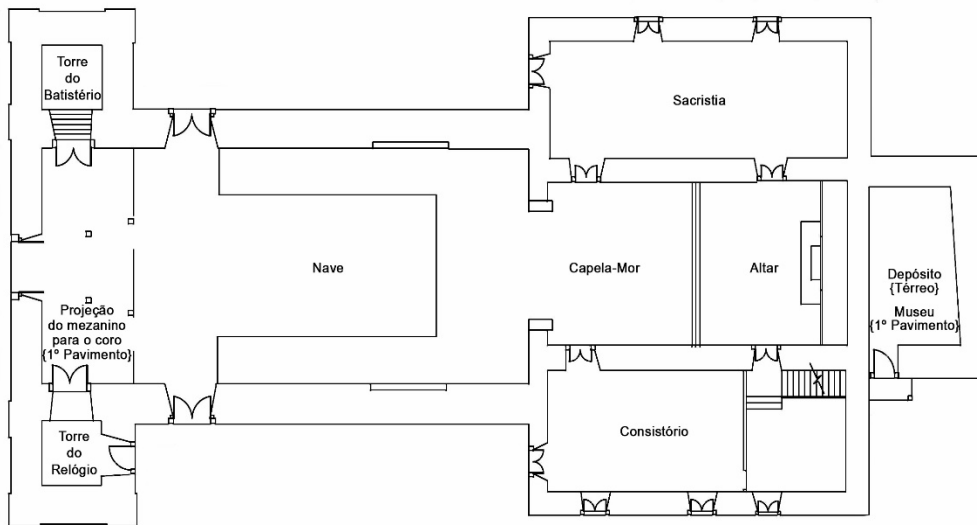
Planta baixa da Igreja Matriz de Pirenópolis/GO.
